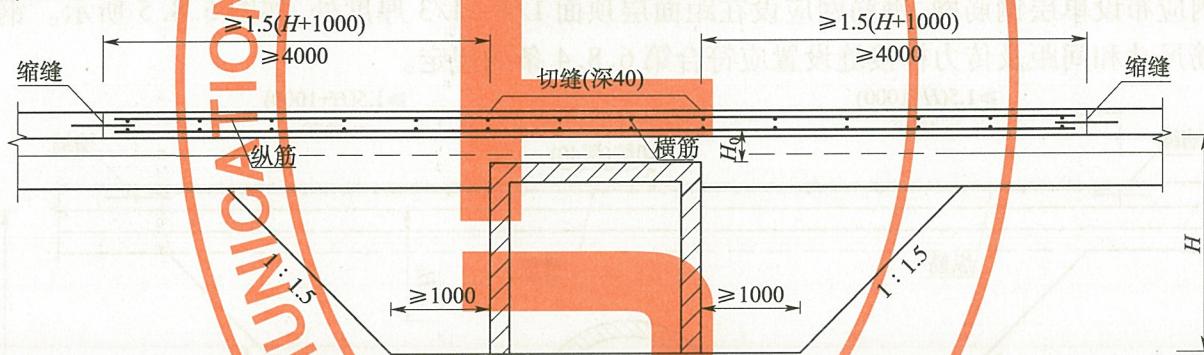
箱形构造物横穿时的面层配筋($H_0 < 800\text{mm}$)(单位:mm)
